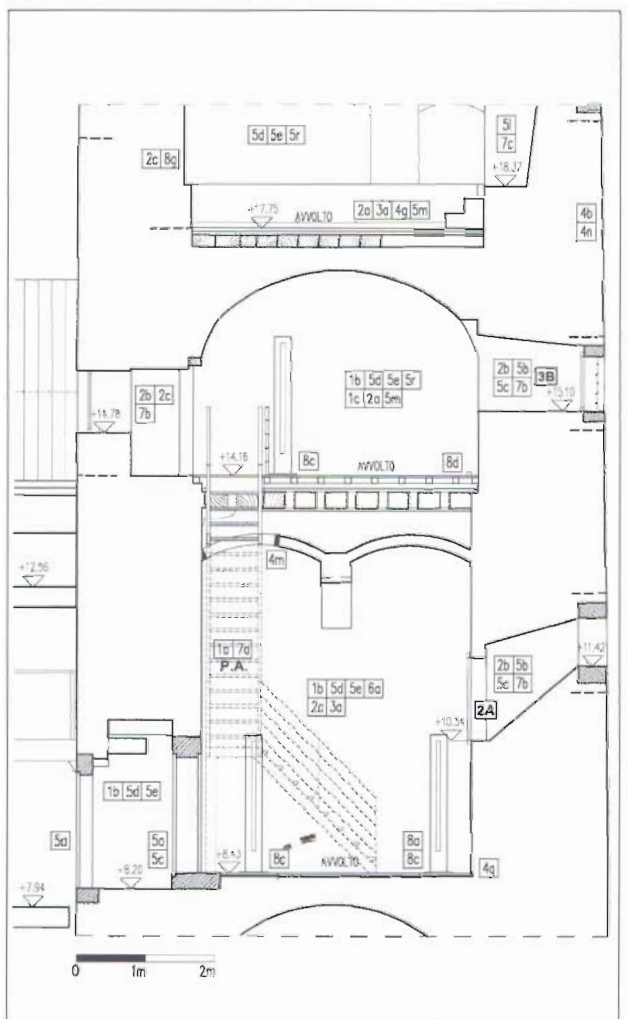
Progetto esecutivo, progetto: sezione BB.
